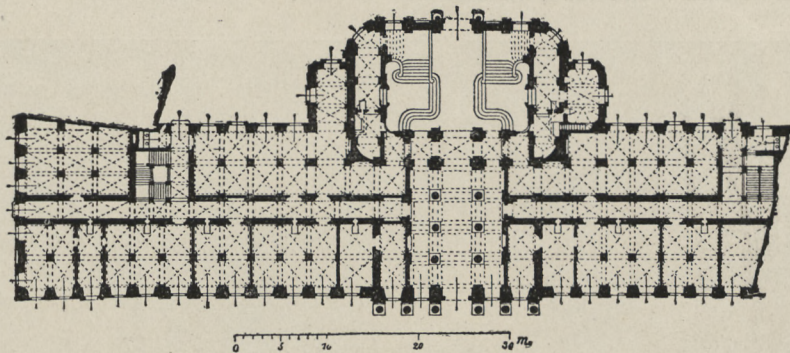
Landhaus, Grundriss des Erdgeschosses.
